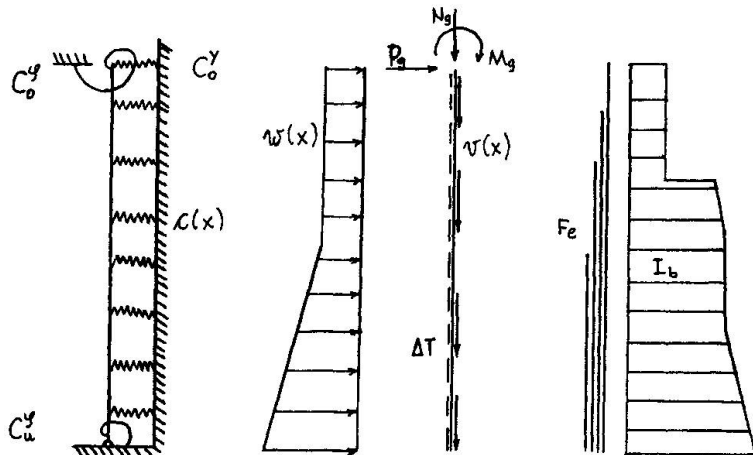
Art der Lagerung, Art der Belastung und Verteilung des Bewehrungsstahles und der Betonträgheitsmomente des Stabmodelles
